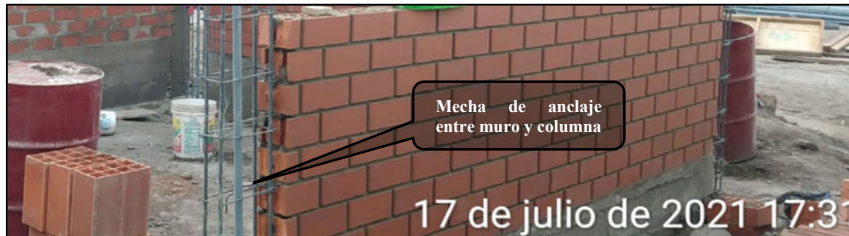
Verificación de Mecha de anclaje entre muro y columna
